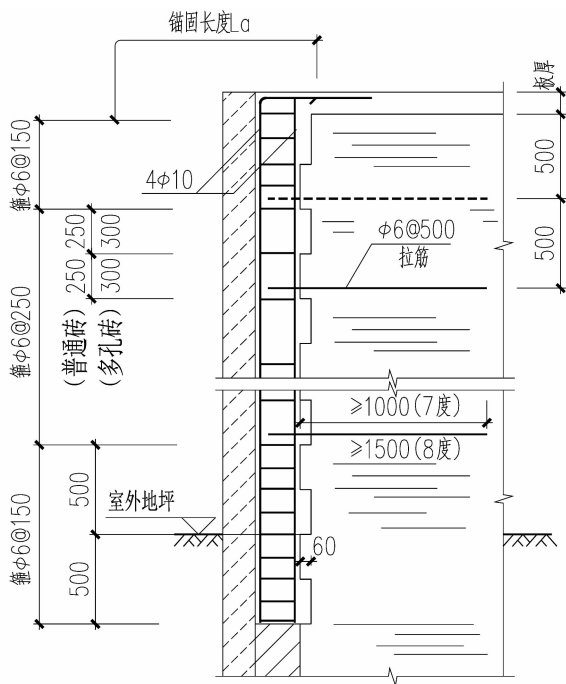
构造柱做法及配筋构造详图(单位:mm)
